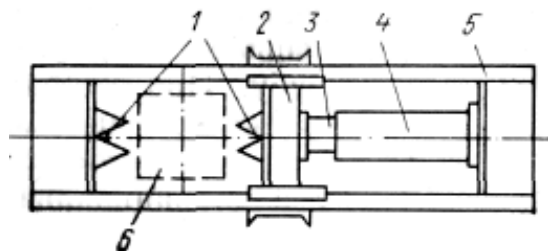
Схема установки для срубания голов свай: 1 – зубья; 2 – рама; 3 – поршень; 4 – гидродомкрат; 5 – станина; 6 – свая
